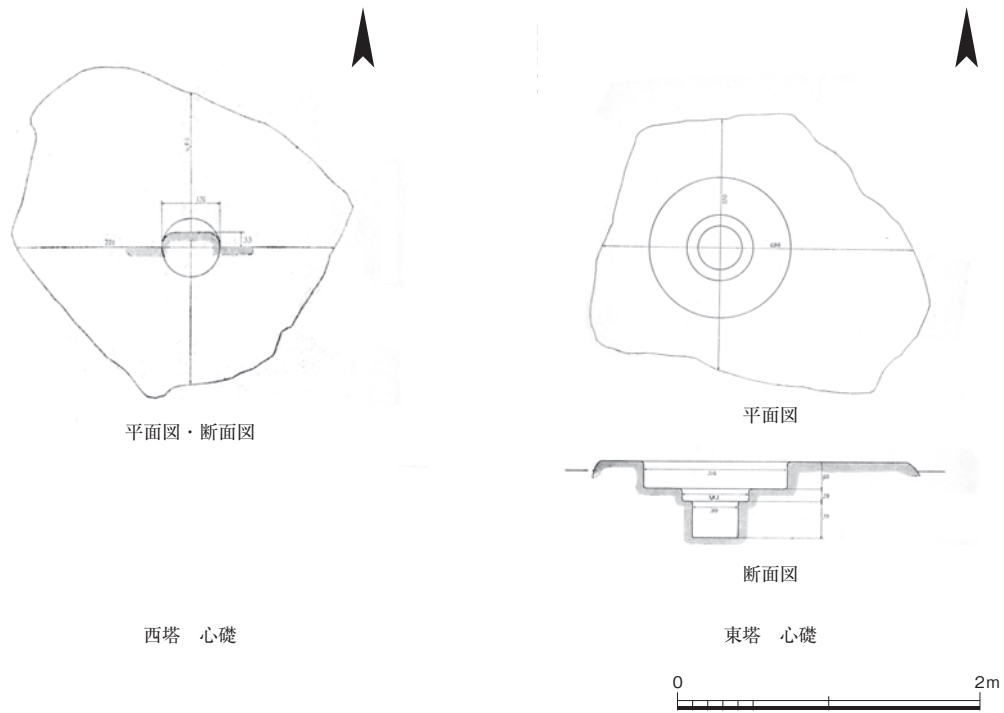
本薬師寺東西塔心礎 平面図・断面図 1:50
